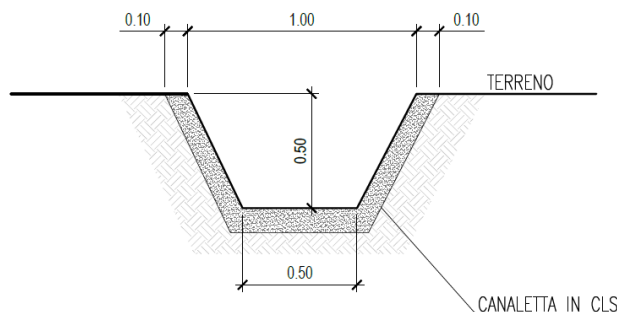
Tipologia di sezioni trapezie in calcestruzzo utilizzate – CANALETTA TIPO 1
